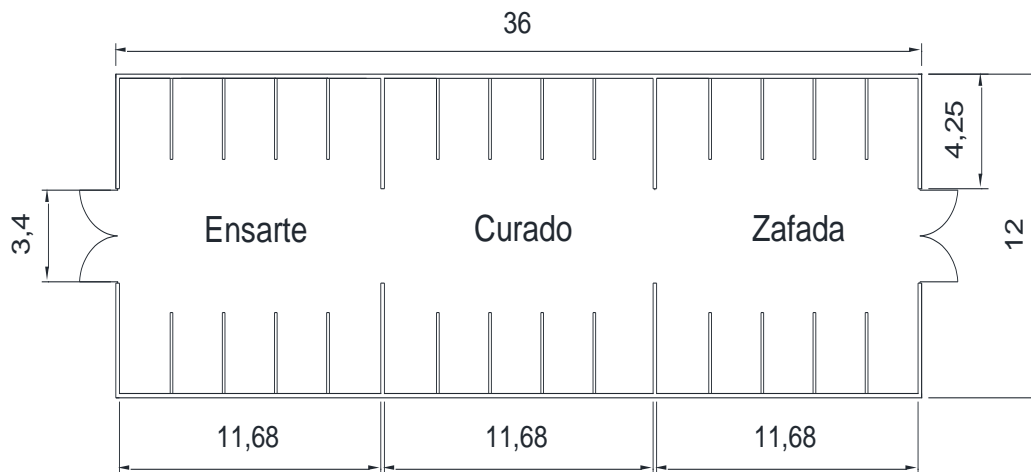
Planos de las áreas de ensarte, curado y zafada
